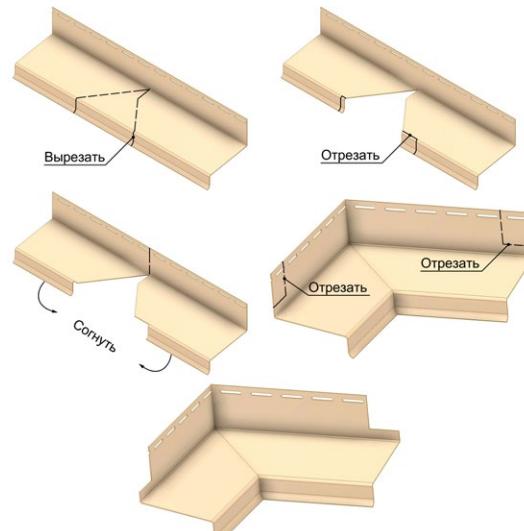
Изготовление внутреннего углового элемента отлива Döcke.
